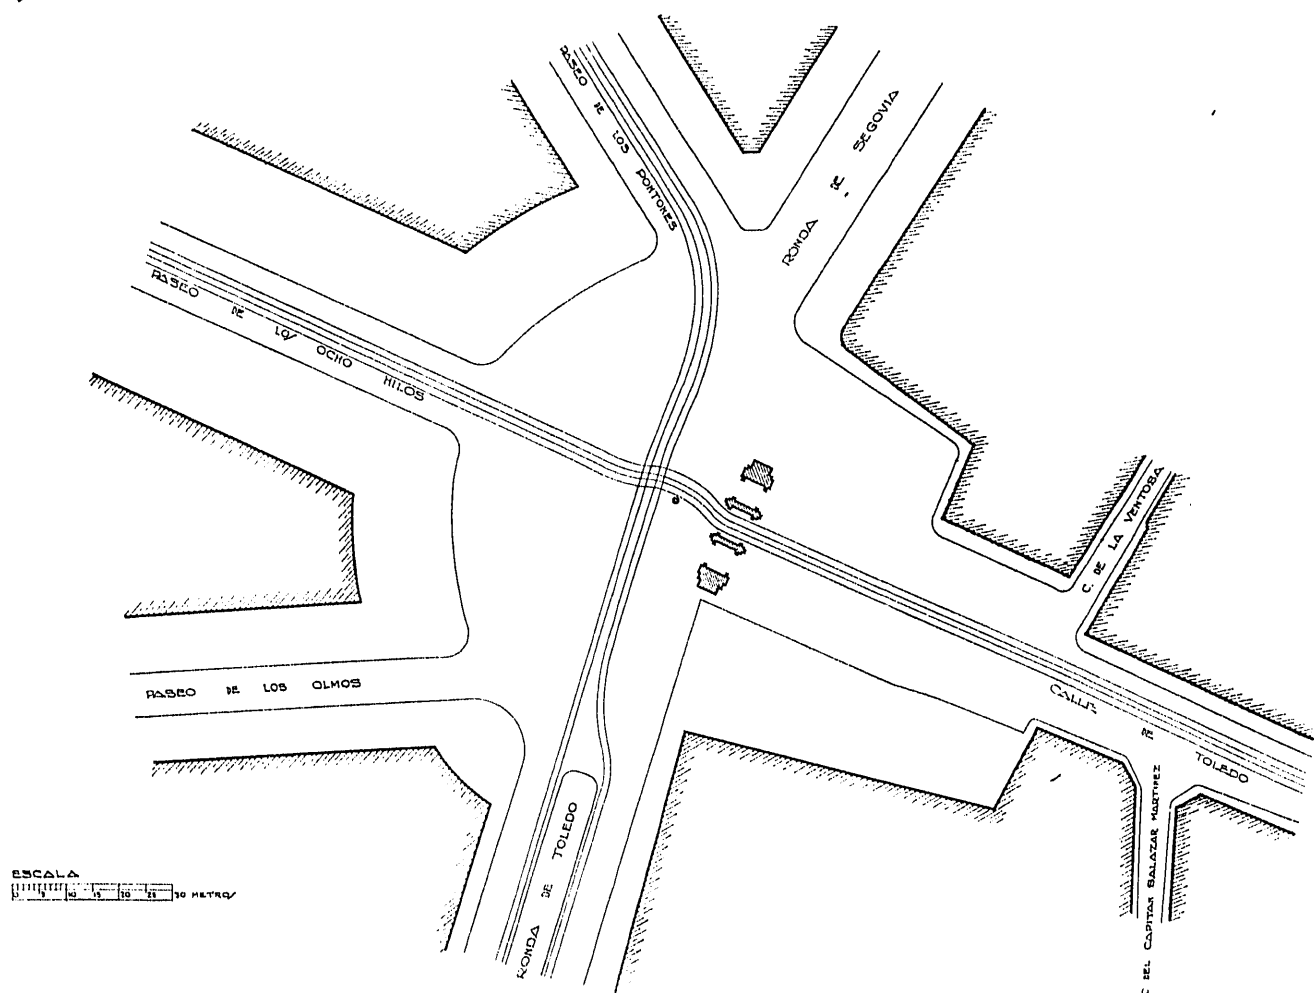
Planta antigua de la Glorieta de la Puerta de Toledo
